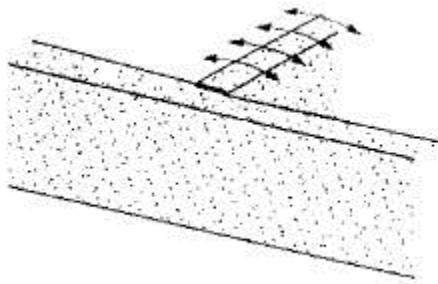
Grietas verticales en unión entre muros, separación entre muros (The Getty Conservation Institute, 2002)
